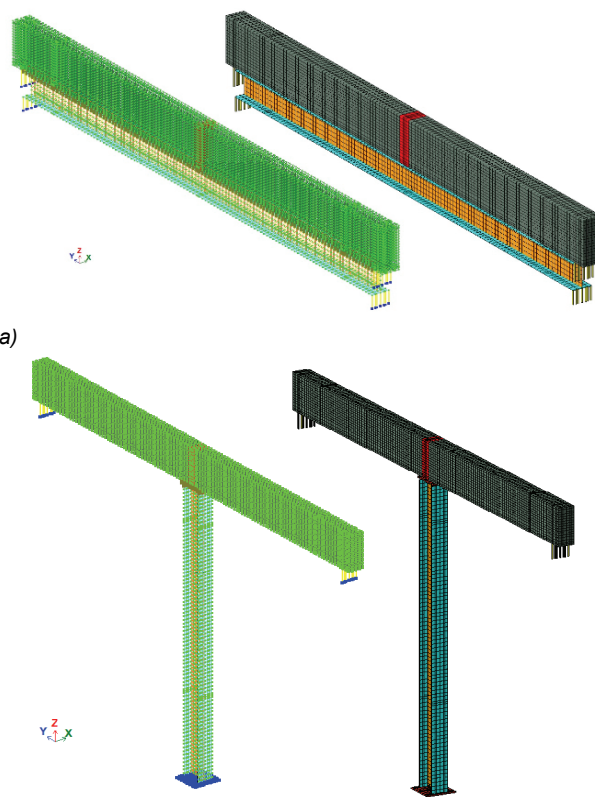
Расчетная схема и 3D-вид усиления прогона: а) – подведение упругой опоры, б) – подведение жесткой опоры
